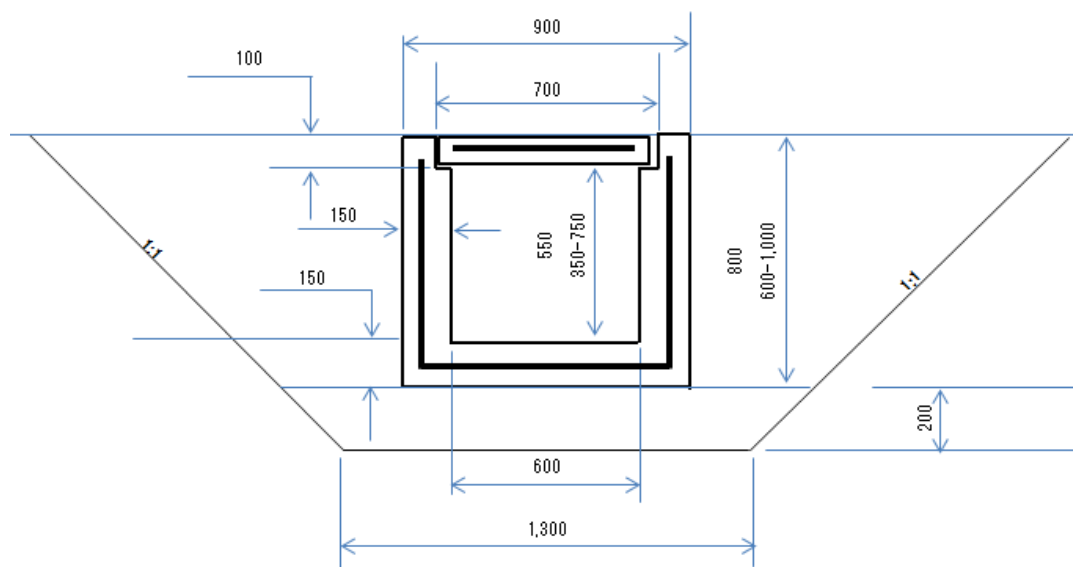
Section typique de drainage dans la zone à conteneurs
